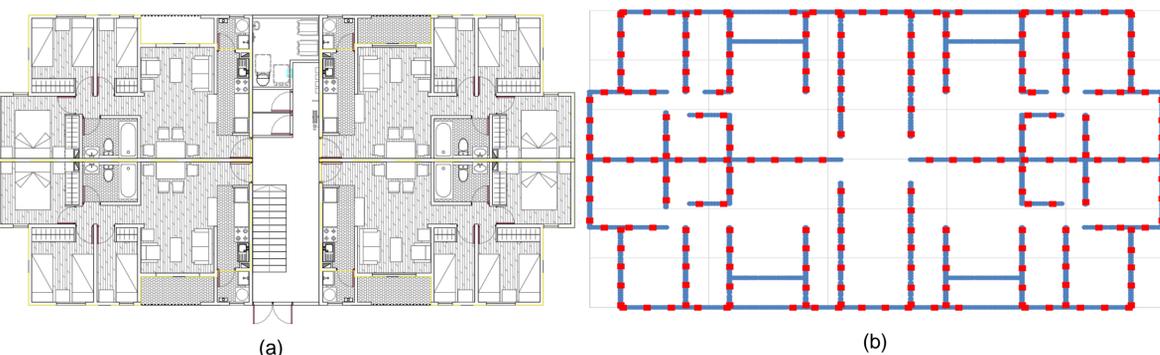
(a) Planta edificio en estudio – (b) Representación esquemática disposición Angle Bracket en planta
